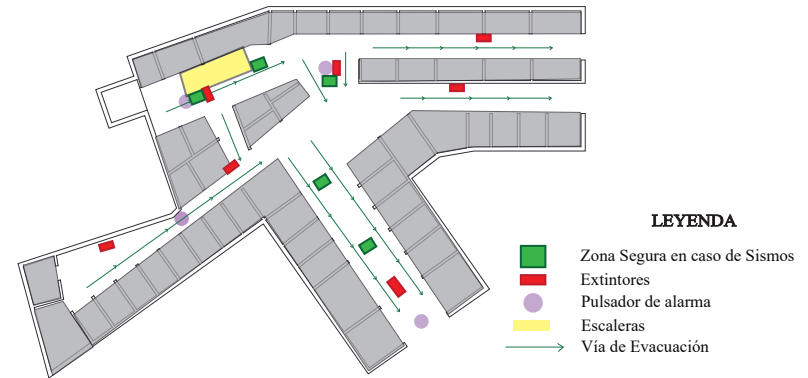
Plano de evacuación de la galería Mesa Redonda.⁸²
